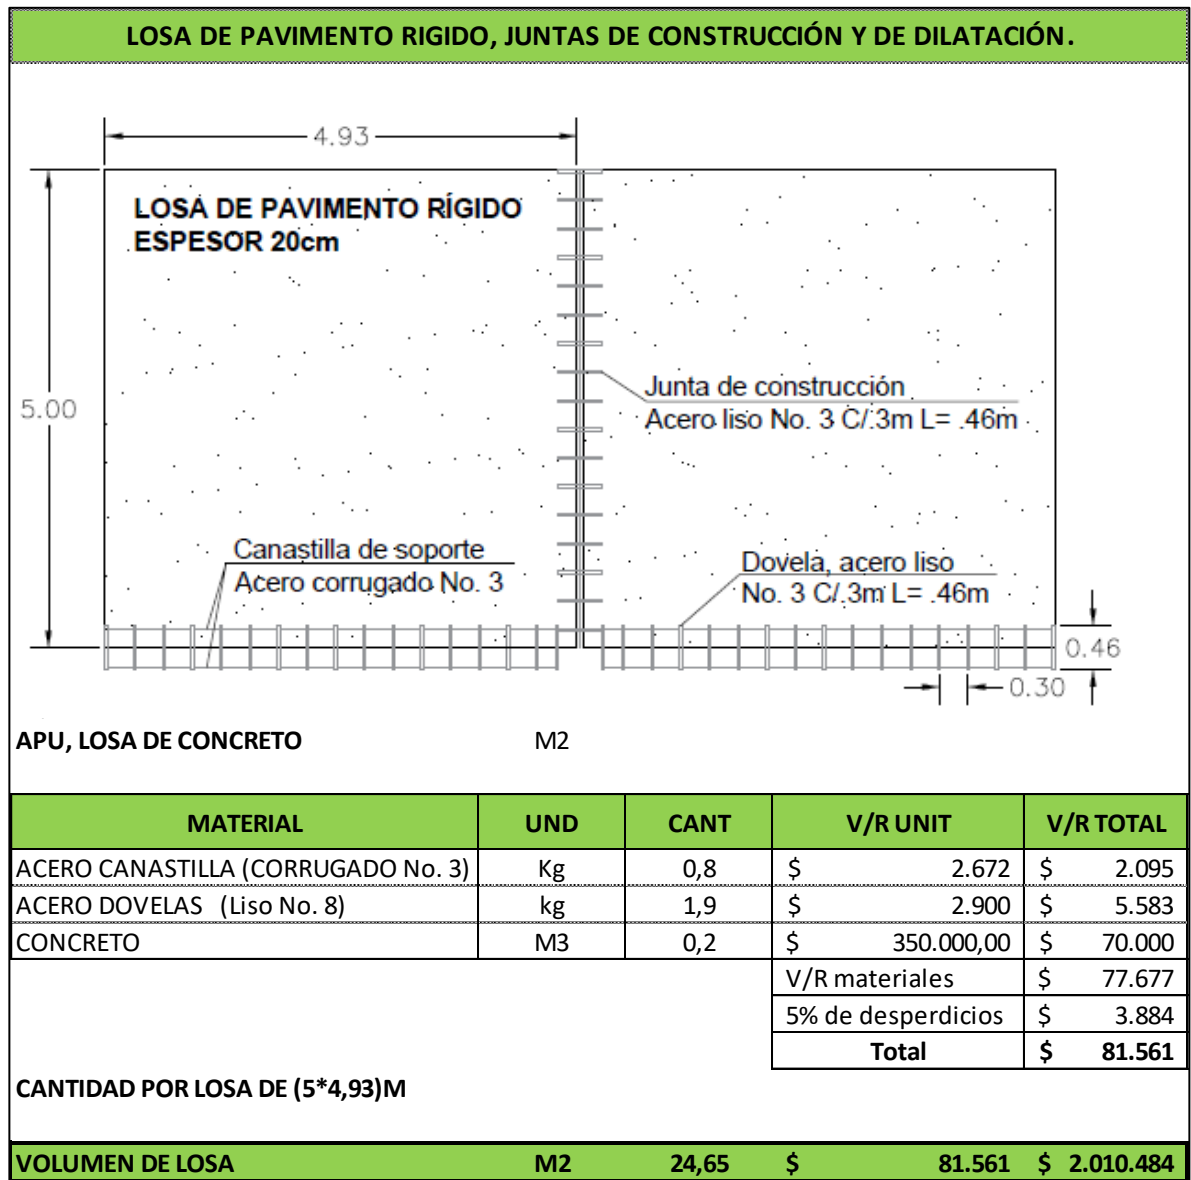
Cantidad de obra, losa pavimento rígido. Tabla Excel (Fuente: Propia)
